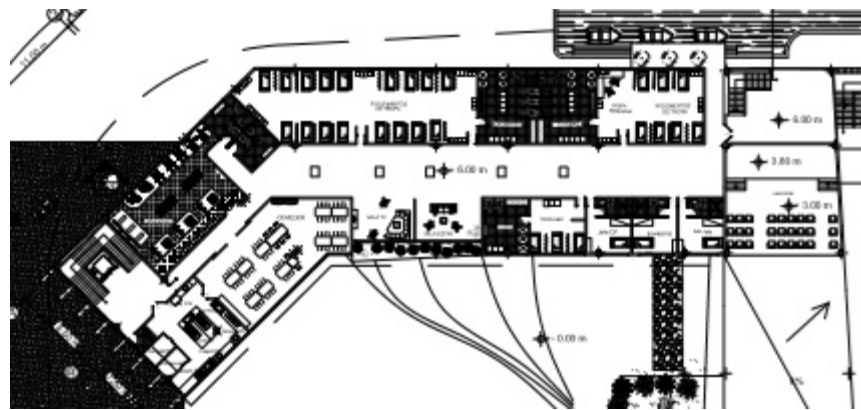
Planta nivel 1, módulo 3, nivel +6.00. (2019)
